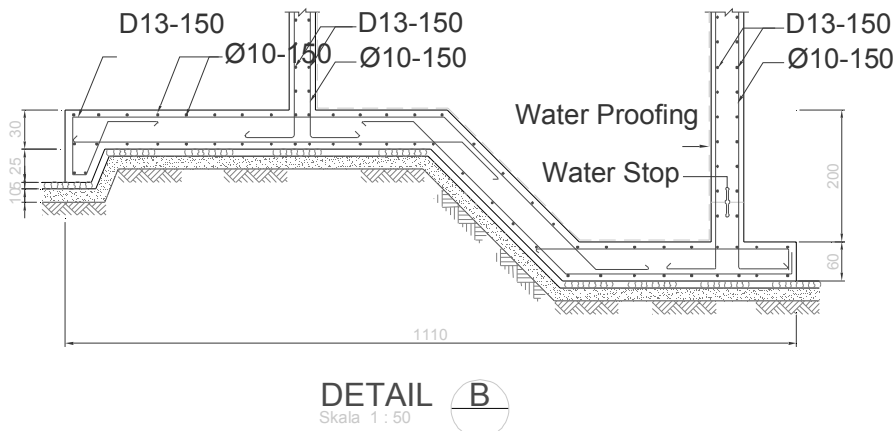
Potongan 5 bangunan pengambilan bendung
